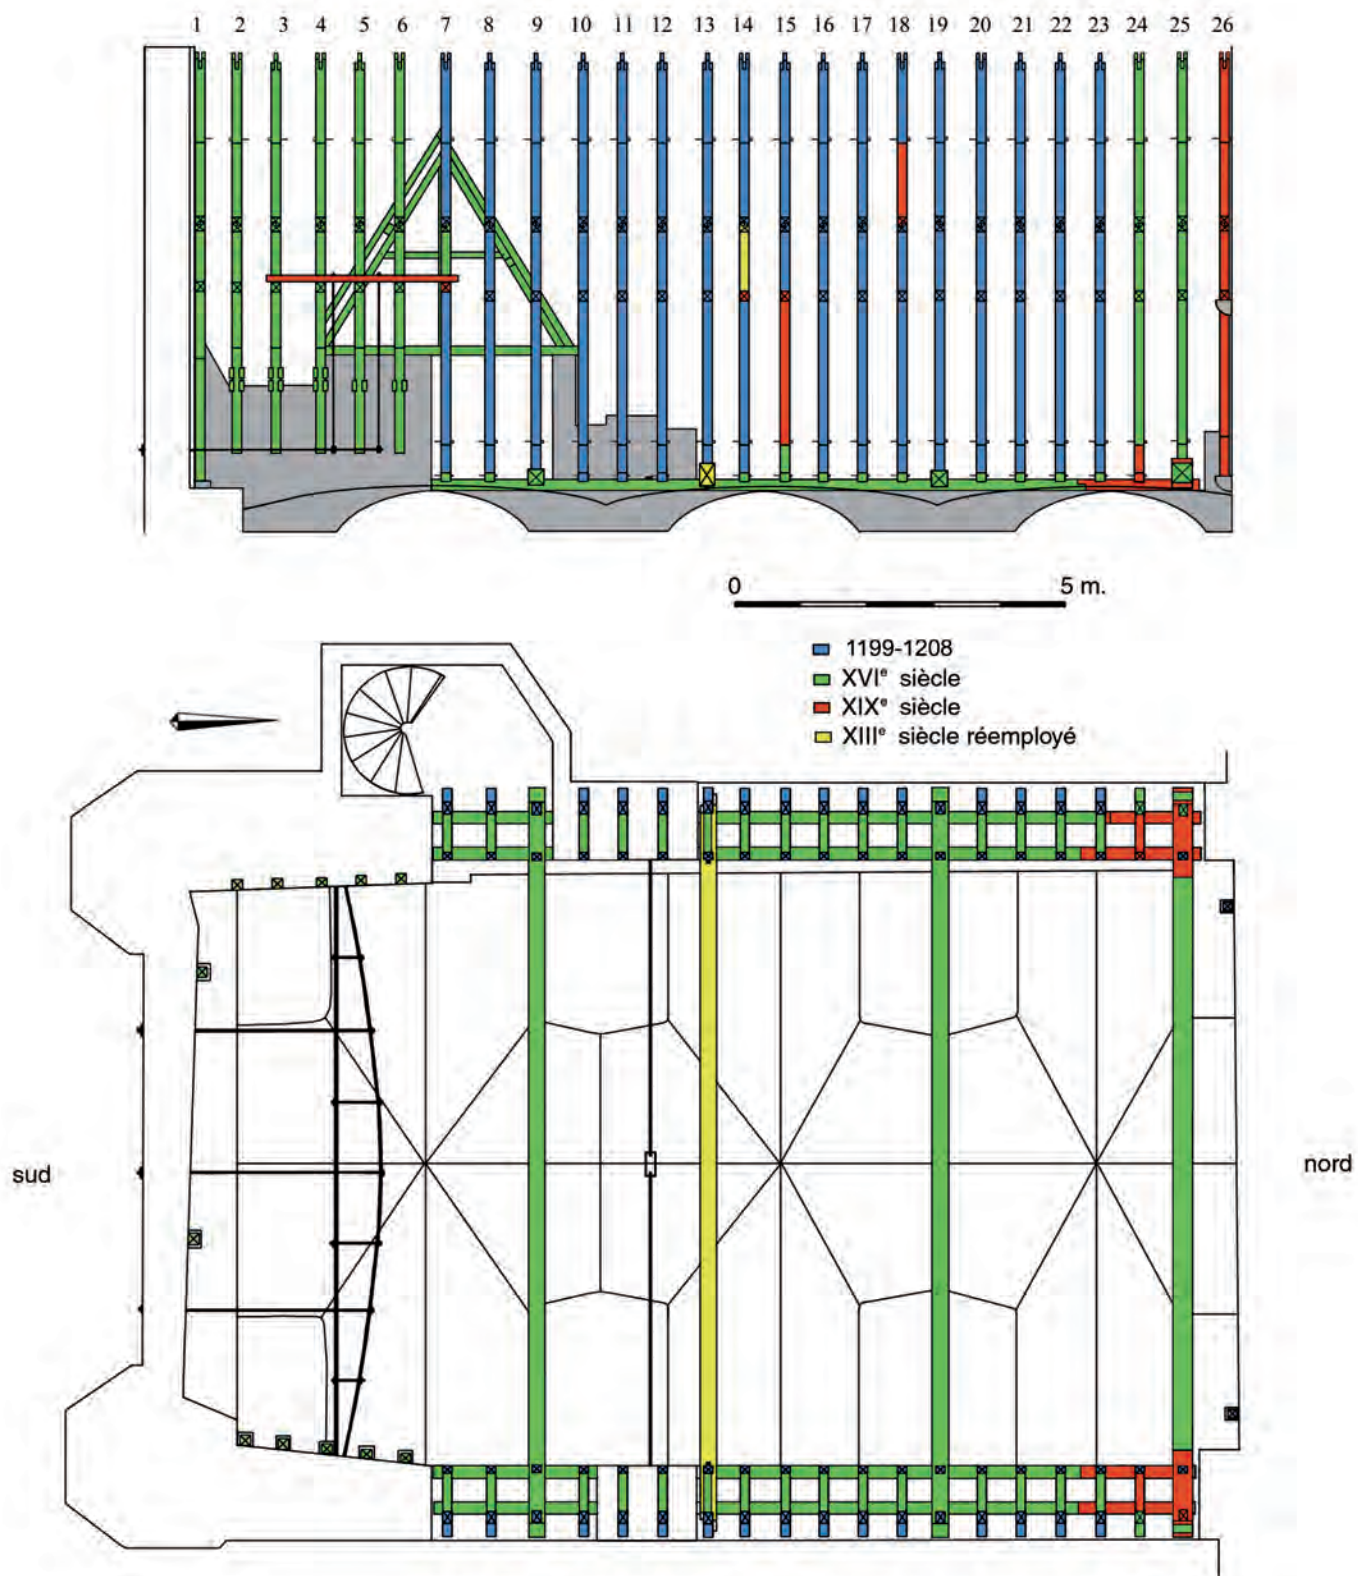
Charpente du croisillon sud (1199-1208d) : coupe longitudinale sud-nord et plan au niveau des entrails.
